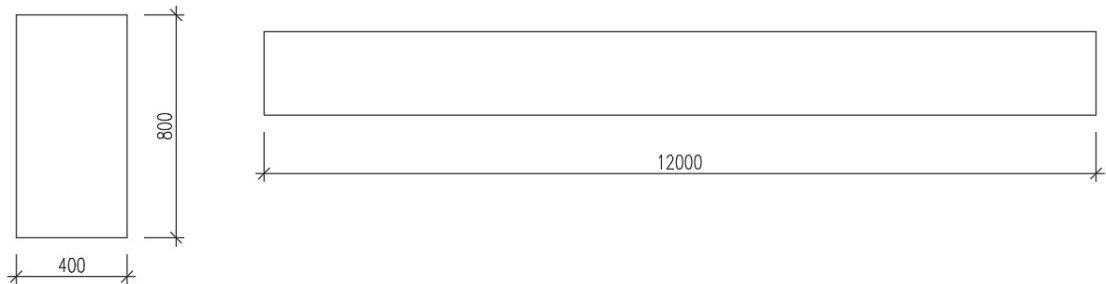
Průřez a schéma parapetního nosníku P3
